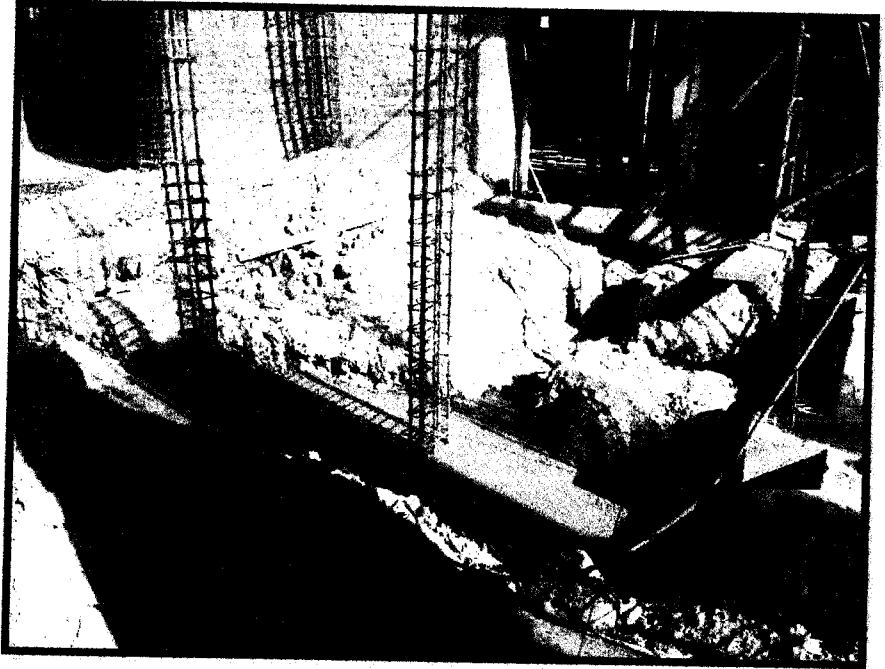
Vaciado de concreto 1er cuerpo – Tanque Elevado
